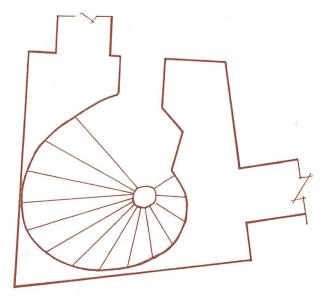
المسقط الأفقى لمسجد الصيرفى بقليشان مقياس رسم ١٠٠٠
